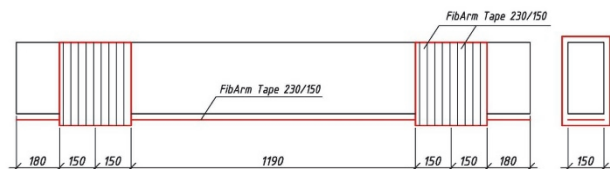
Схема оклейки железобетонных моделей углеродными лентами
